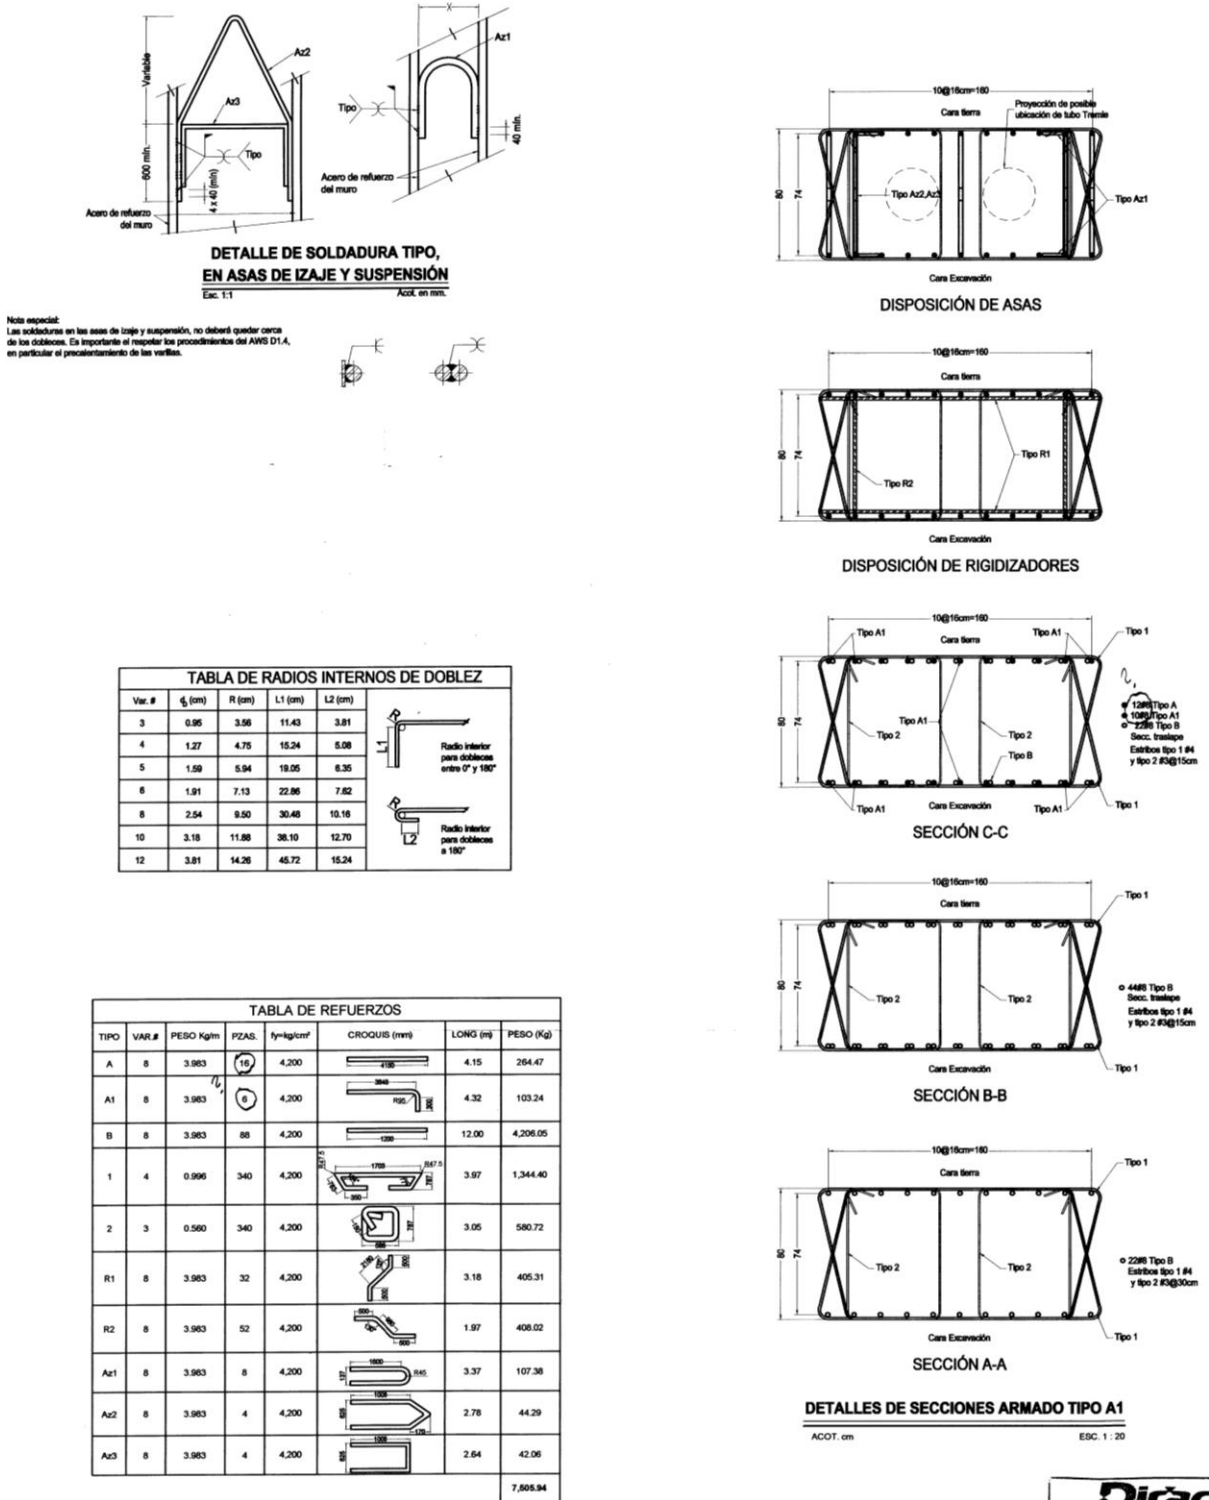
Acero de refuerzo utilizado para los paneles del muro Millán.
